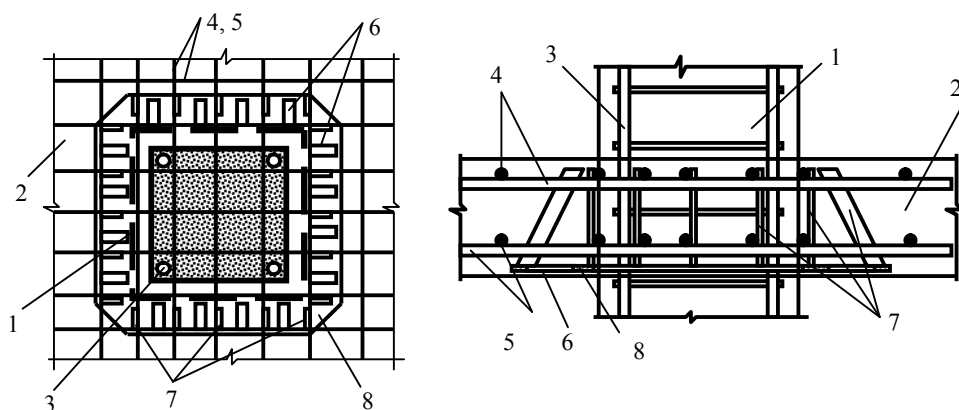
Схема узла опирания плиты безбалочного перекрытия на колонну
